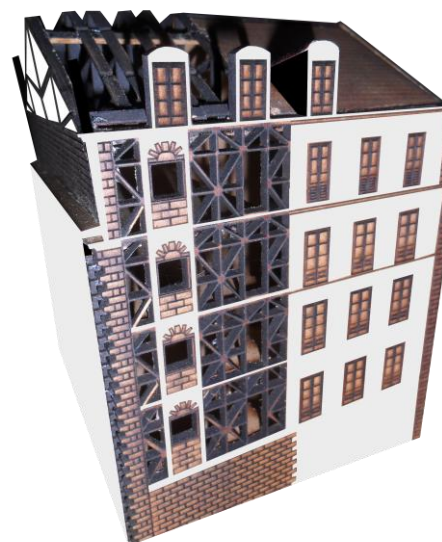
Maqueta tridimensional, expositiva (costas) do género construtivo (esq.) e fachada Reabilitada (dir.) retocada, criação do autor. Escala 1/100
